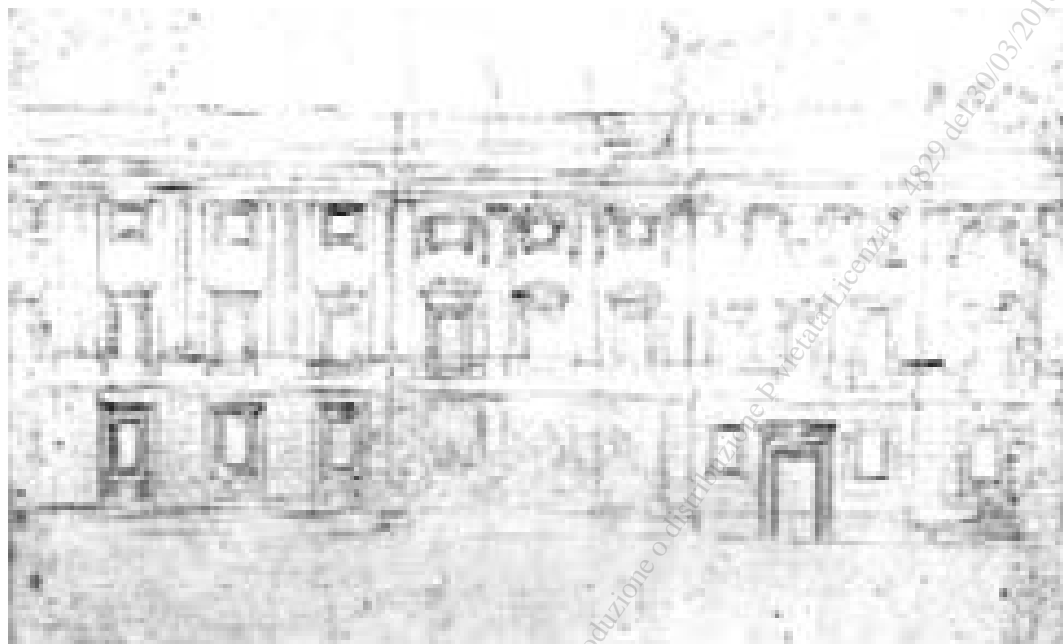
Progetto per il palazzo Chigi a piazza Colonna, prospetto (BAV, Chigi, P VII 10, f.12r)
